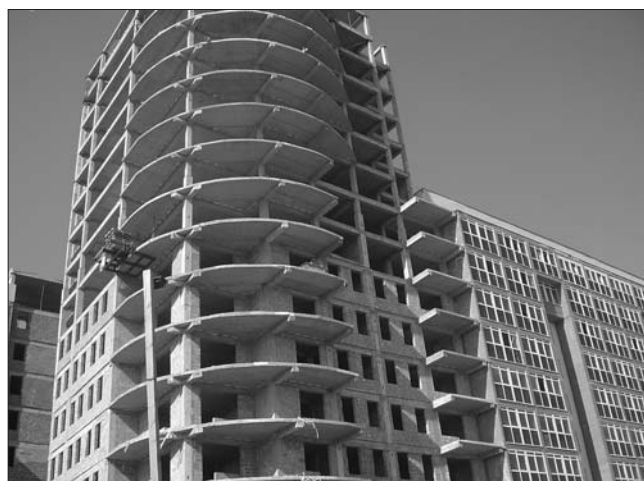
Строительство 16-этажного жилого дома в Нижнем Новгороде, р-н Верхние Печоры, с несущим каркасом Saret из сборных керамзитобетонных элементов (2006 г.)
